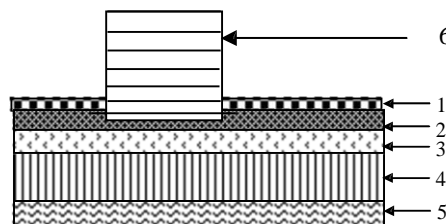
Coupe verticale d'un plancher étage courant - corps creux-
